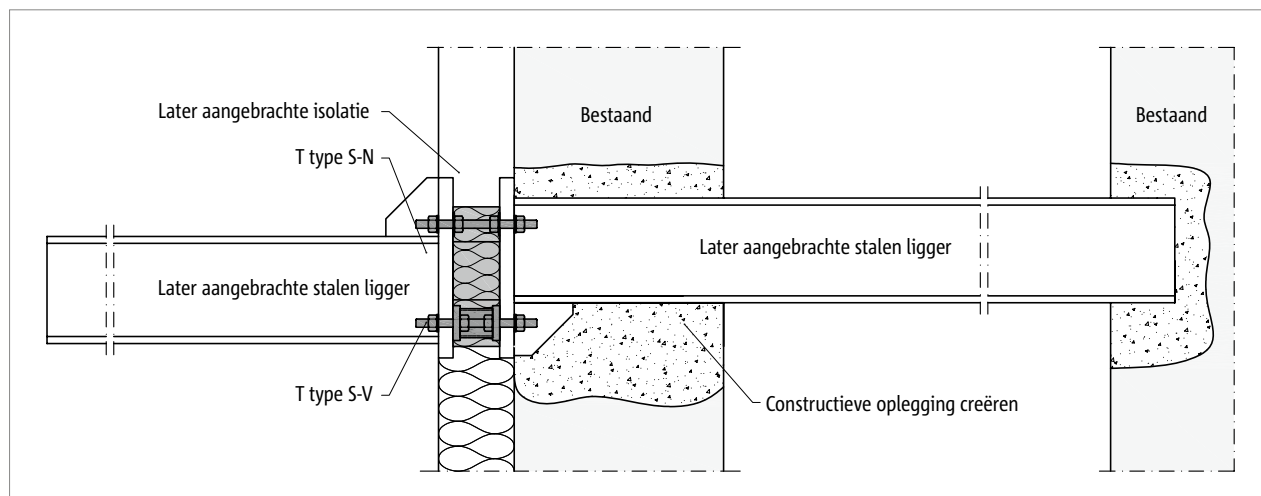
Schöck Isokorf® T type S-N, T type S-V en extra adapter: Achteraf gemonteerd stalen balkon, uitkragend; met trekband aan de bestaande betonvloer verankerd
